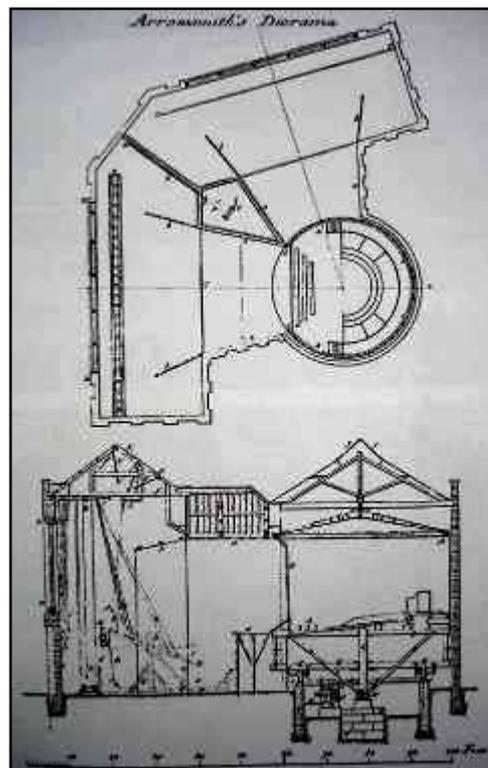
Planta baixa e corte esquemático do Diorama de Daguerre. Um mecanismo de rotação girava o público de uma cena à outra.
